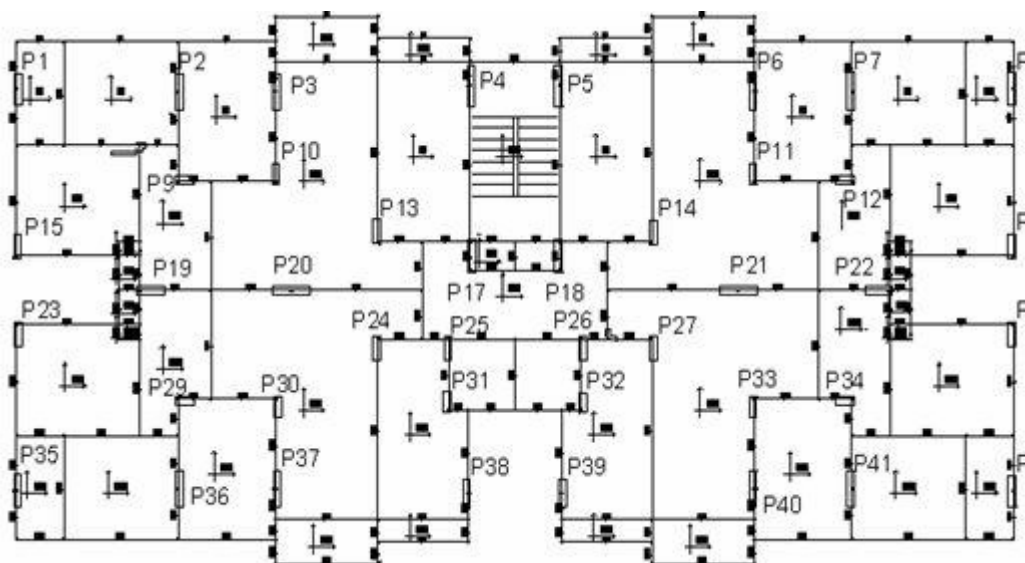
Esquema da distribuição de pilares, vigas e lajes do pavimento tipo – edifício “A”.
